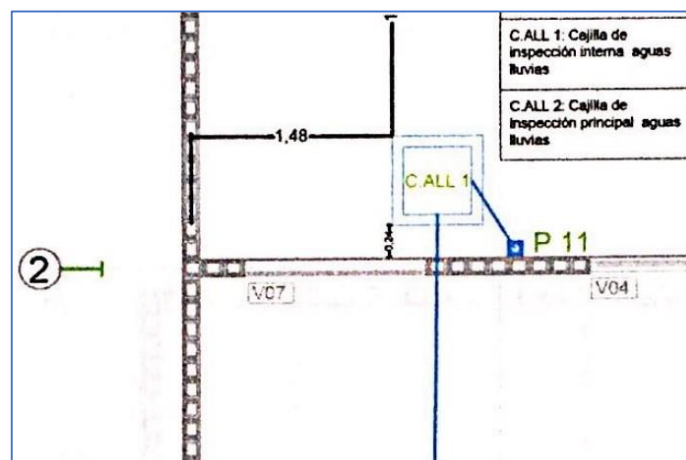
Detalle tubería embebida en viga de cimentación. Obra No.17
